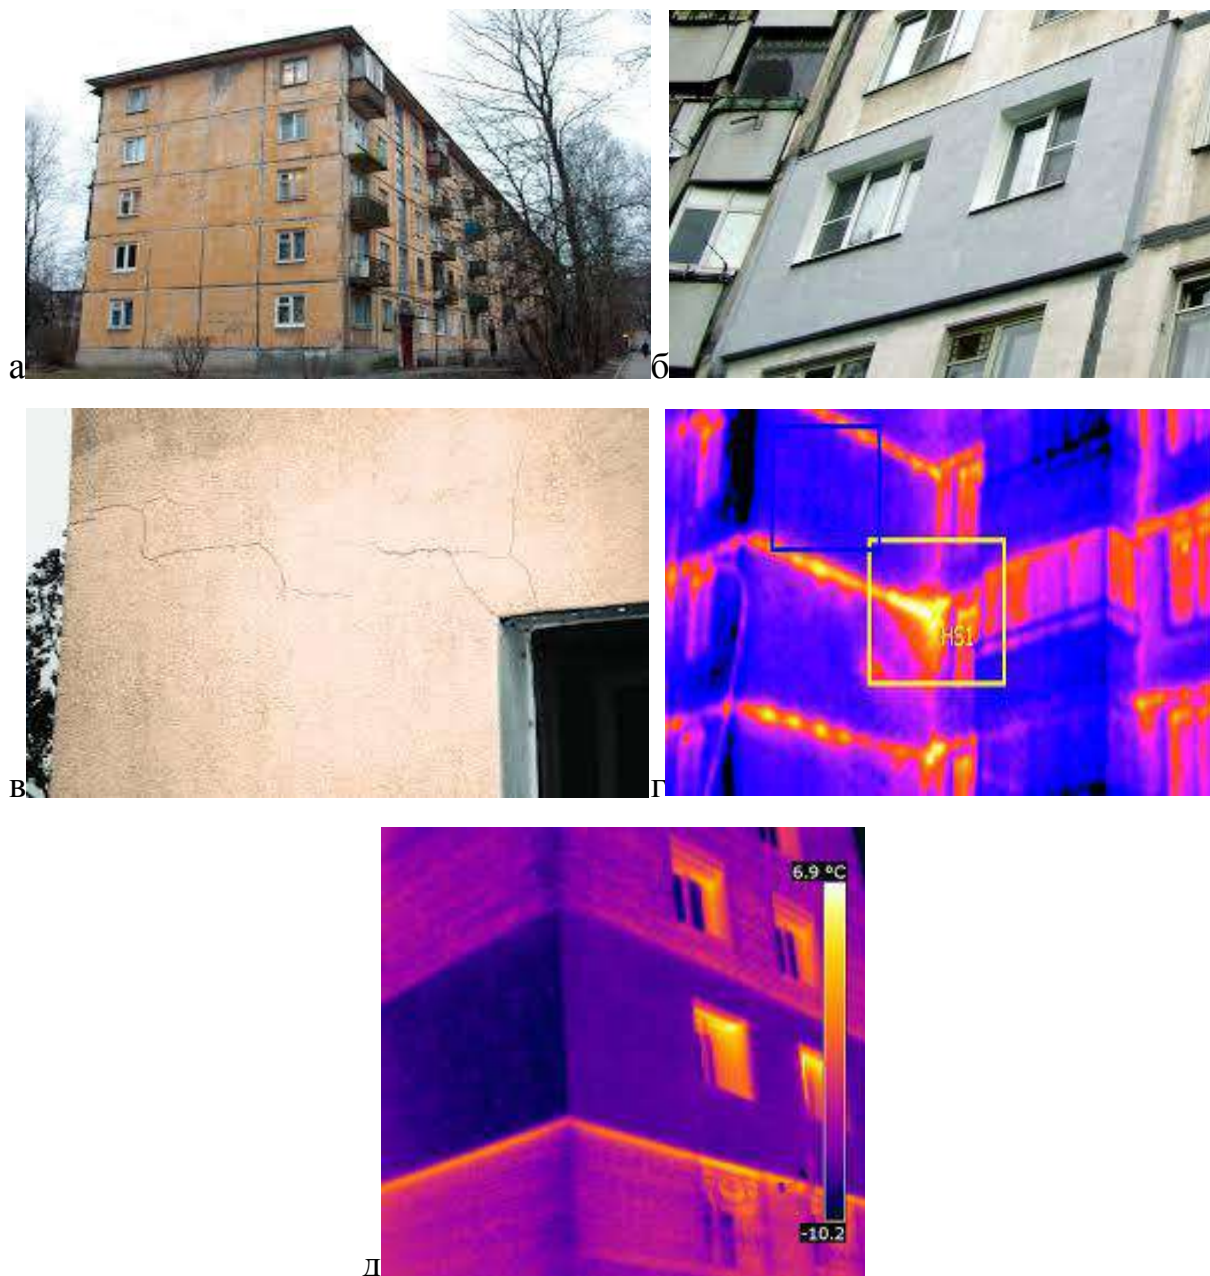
Термограми характерних технологічних дефектів площини фасаду житлової будівлі: а – панельний будинок без утеплення; б – локальні утеплення; в – тріщини утеплювача; г – містки холоду на стиках панелей; д – локальні утеплення та містки холоду.
